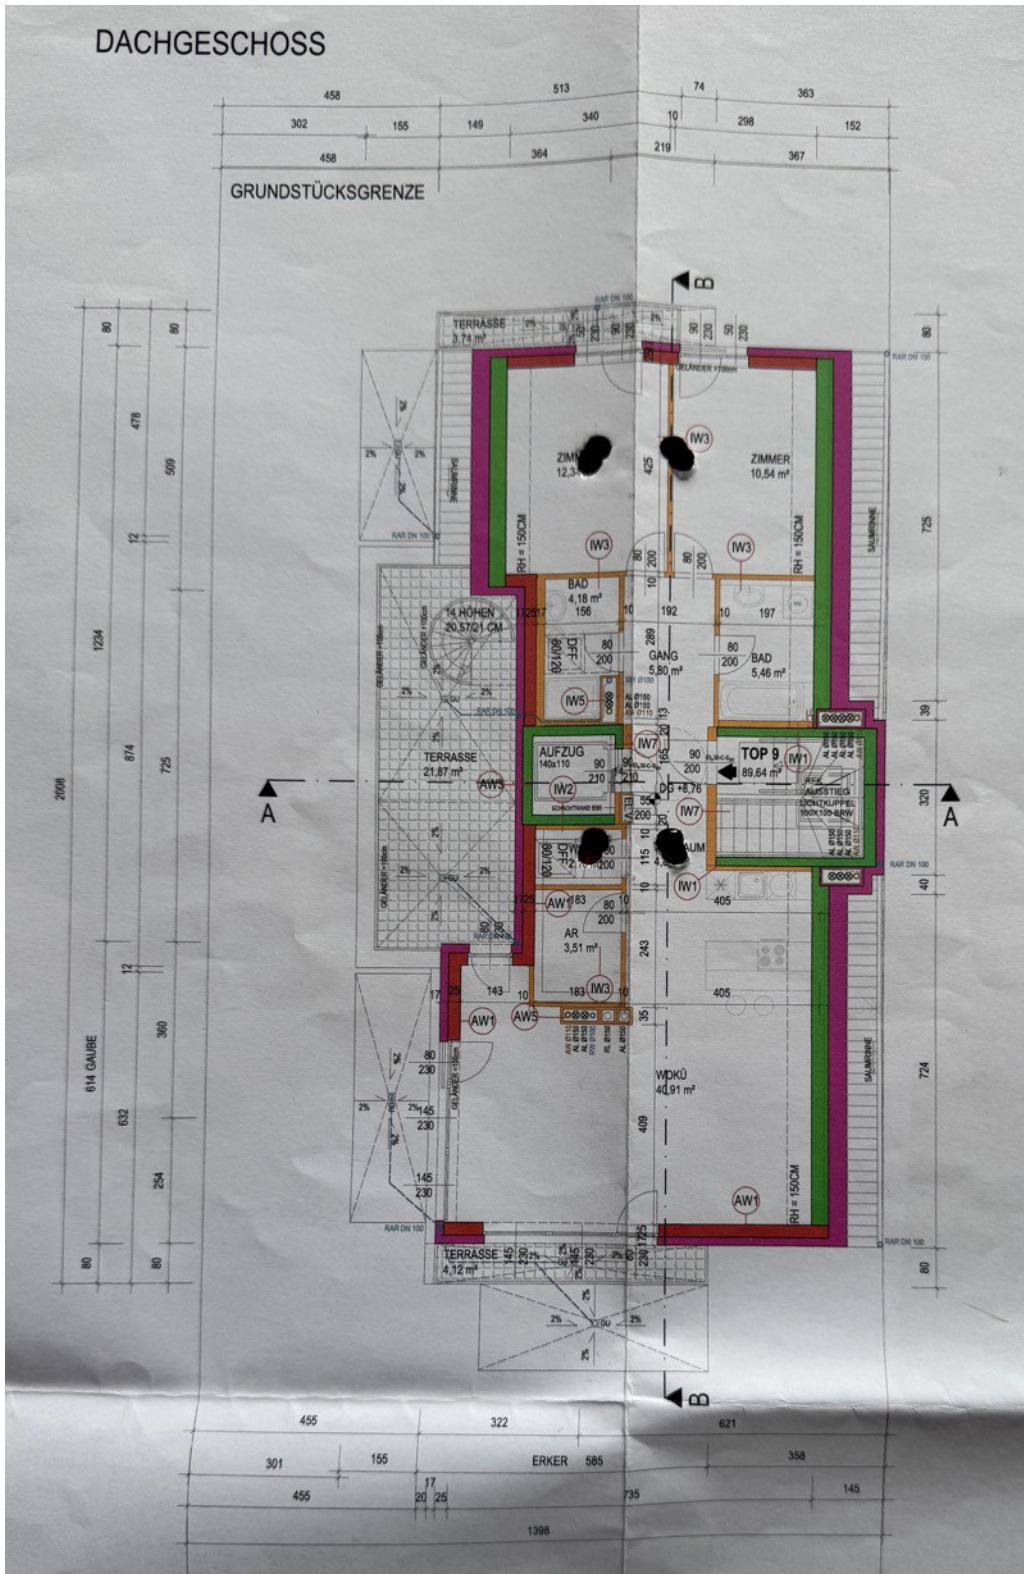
Einreichplan - Dachgeschoß / Quelle: auftraggebende Partei
